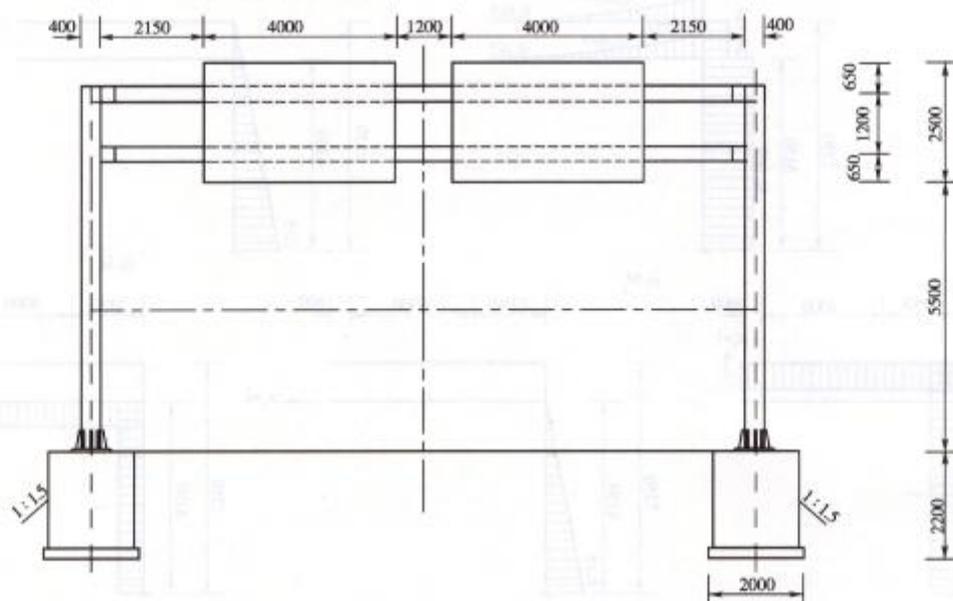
双横梁平面对称刚架结构图(尺寸单位:mm)
